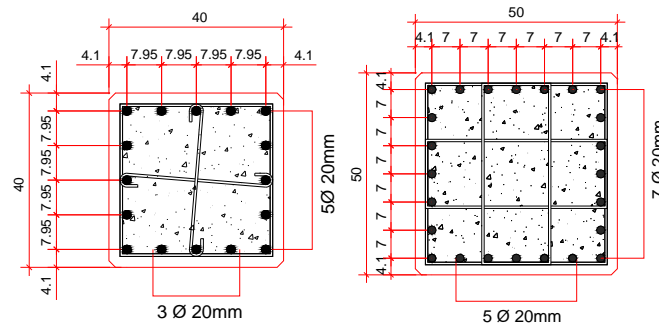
Seção transversal e disposição de armadura dos pilares em concreto pré-moldado
